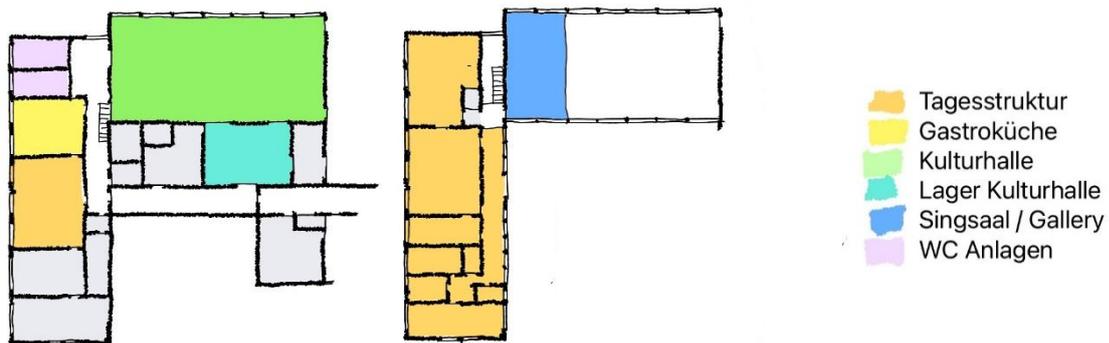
; Schema Tagesstruktur; Erdgeschoss / Untergeschoss
